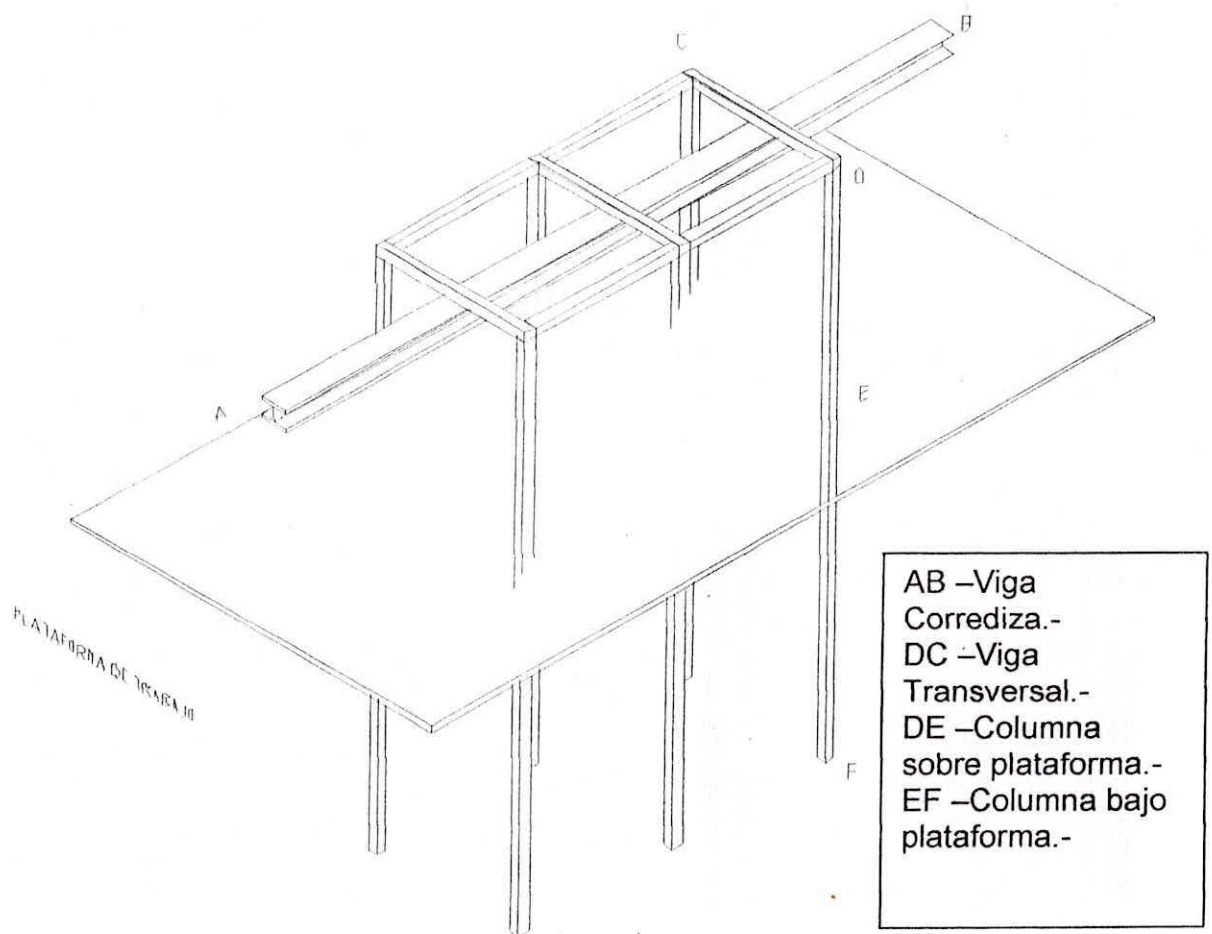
Vista en tres dimensiones de estructura de grúa corrediza
